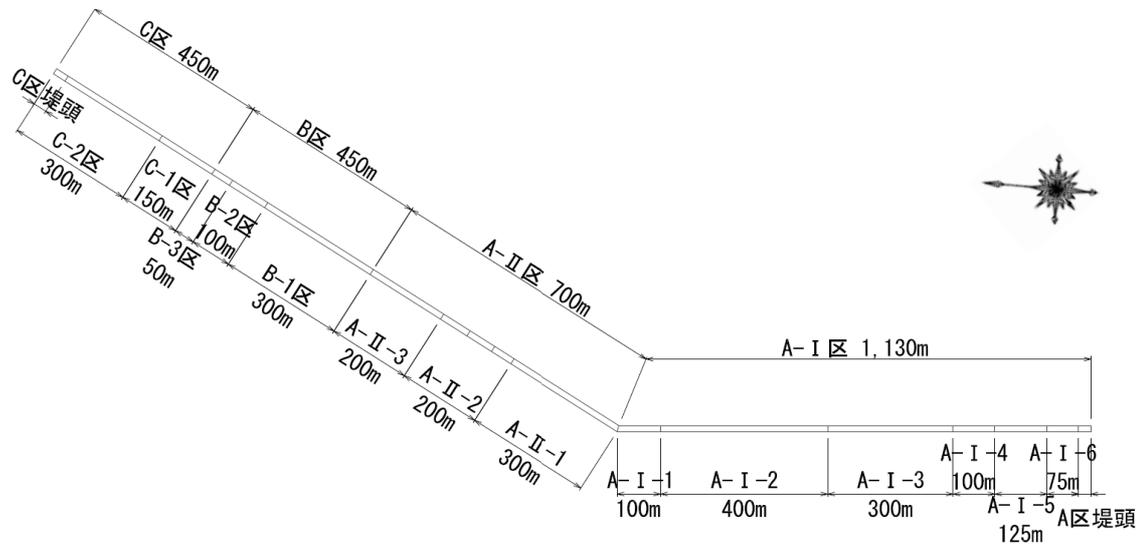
No.1 沖防波堤の平面図 (被災前)
